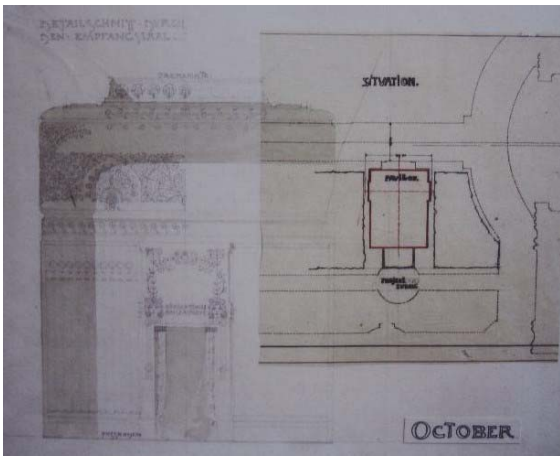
Olbrich: Fassadenaufriss, Grundriss, Jubiläumspavillon, 1897
